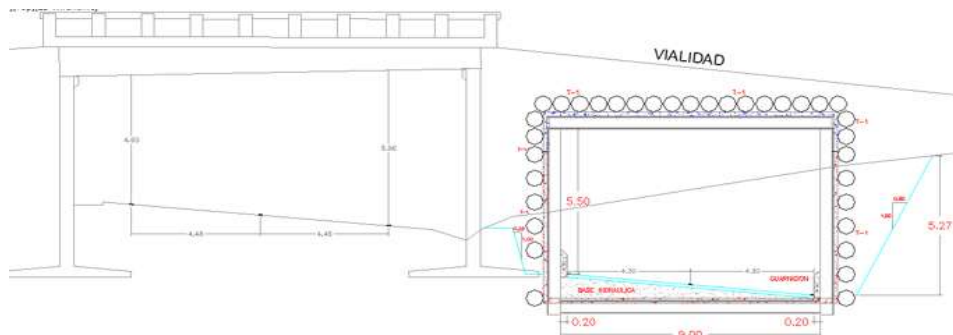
Corte A-A' (Vista Tenango-Ixtapan)
